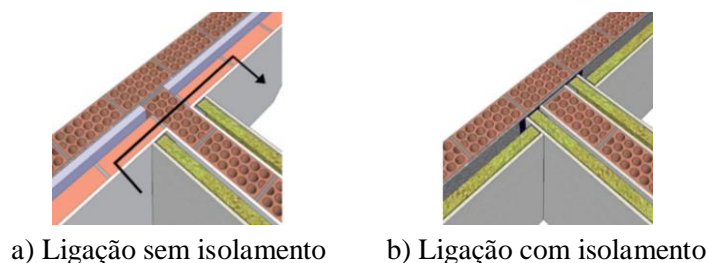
Ponto de ligação entre parede divisória e parede de fachada (COST, 2014)
